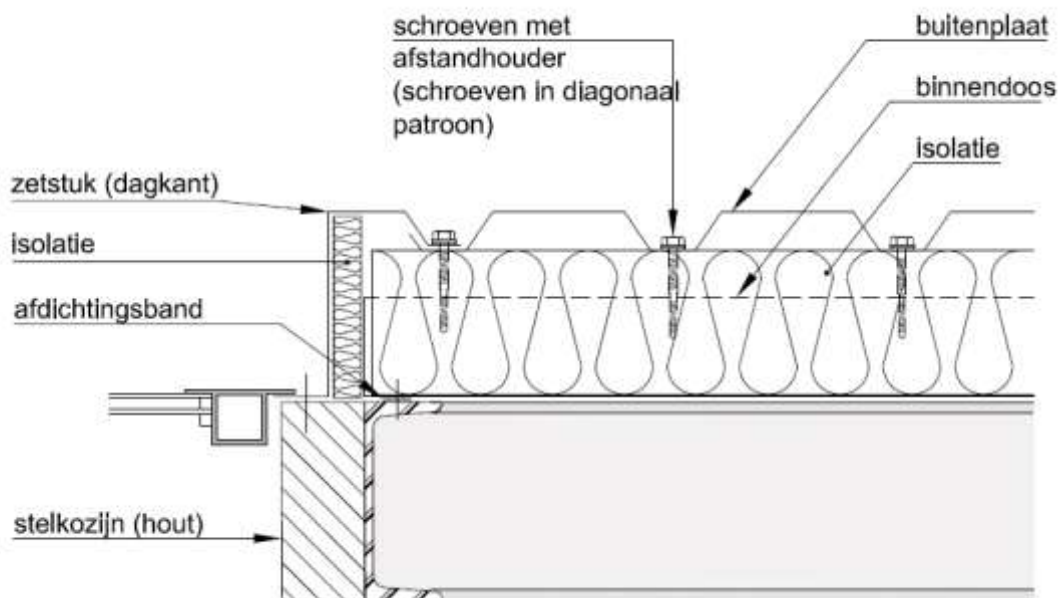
Verticale doorsnede bovenzijde raam.³⁶
